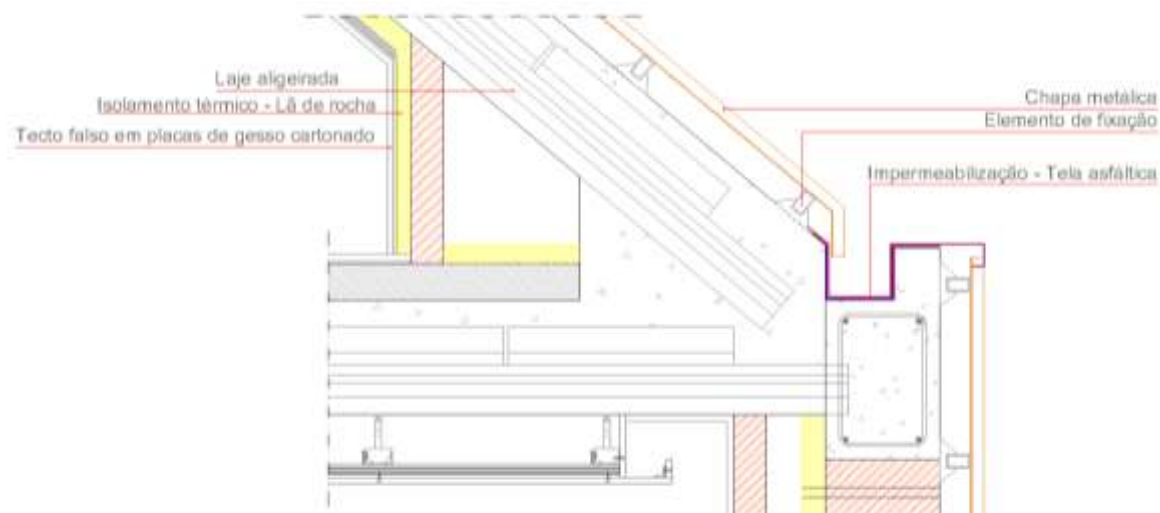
Pormenor construtivo da cobertura inclinada revestida a chapa metálica (P3)
